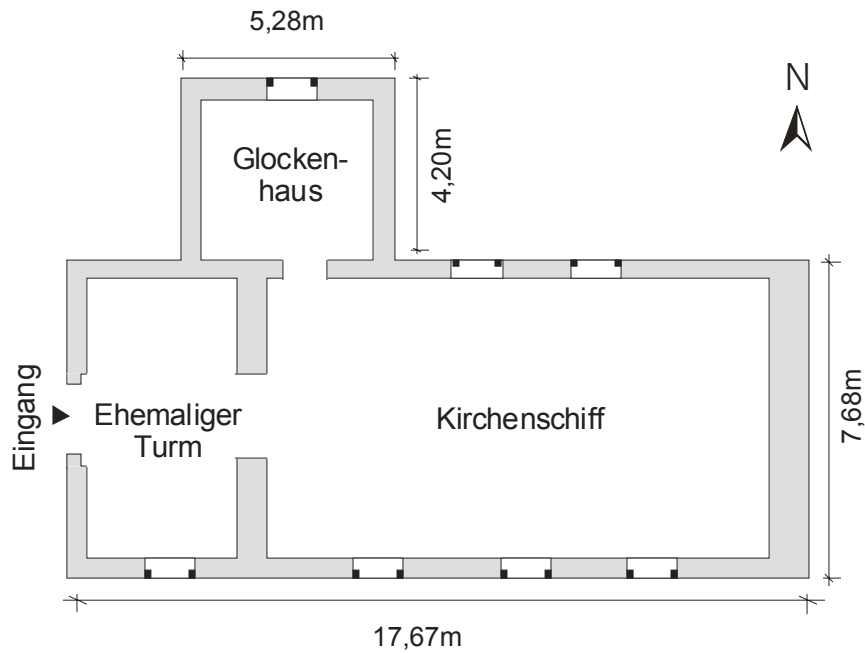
Der Grundriss des Kirchengebäudes von Wittmar
